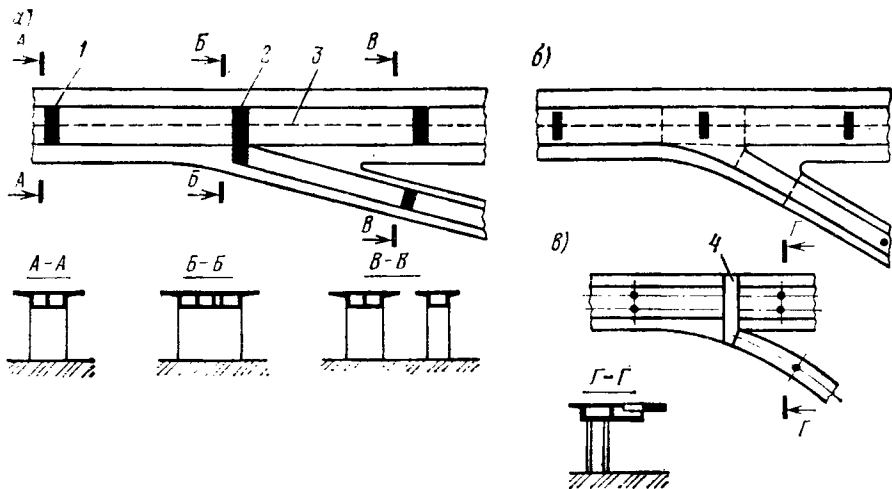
Конструкция ответвлений пролетных строений железобетонных эстакад:
